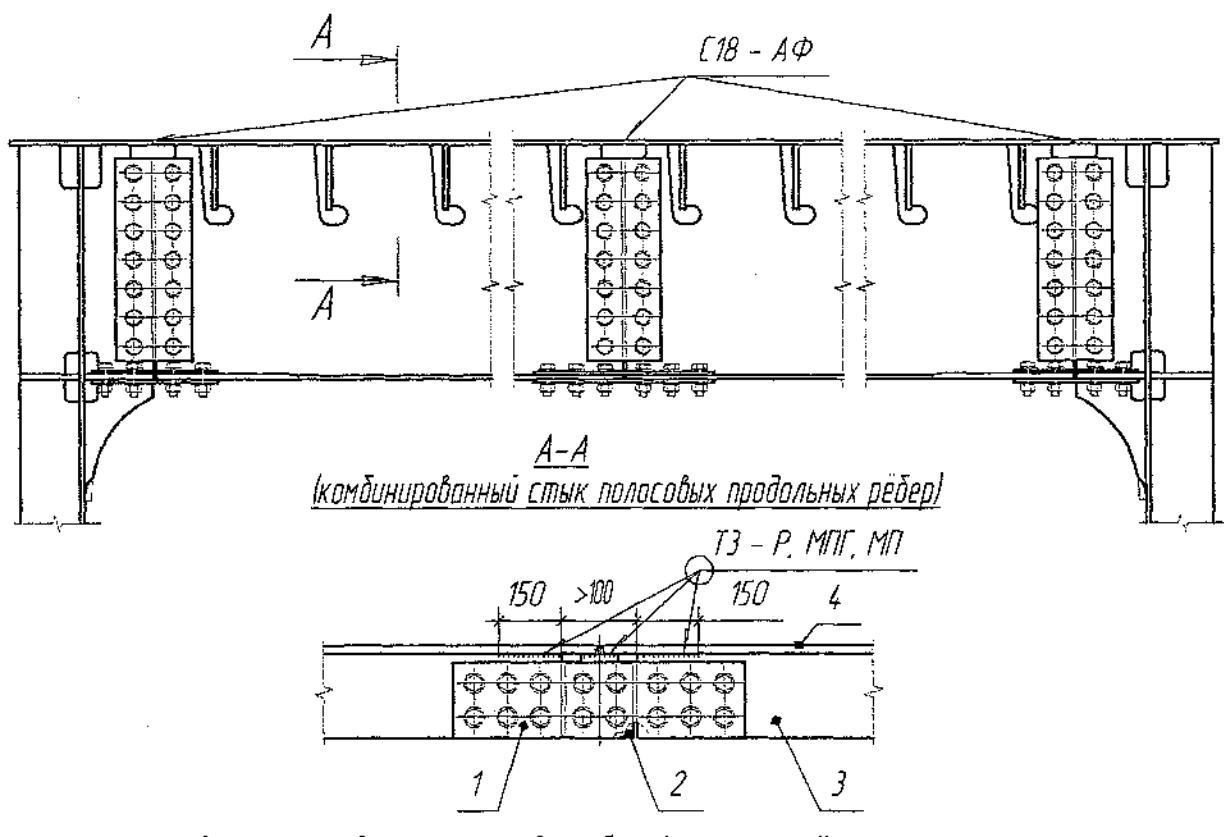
Болтосварныестыки ортотропных плит между собой и с главными балками и стандартное пересечение полосового продольного ребра со стенкой поперечной балки в автодорожных пролётных строениях
